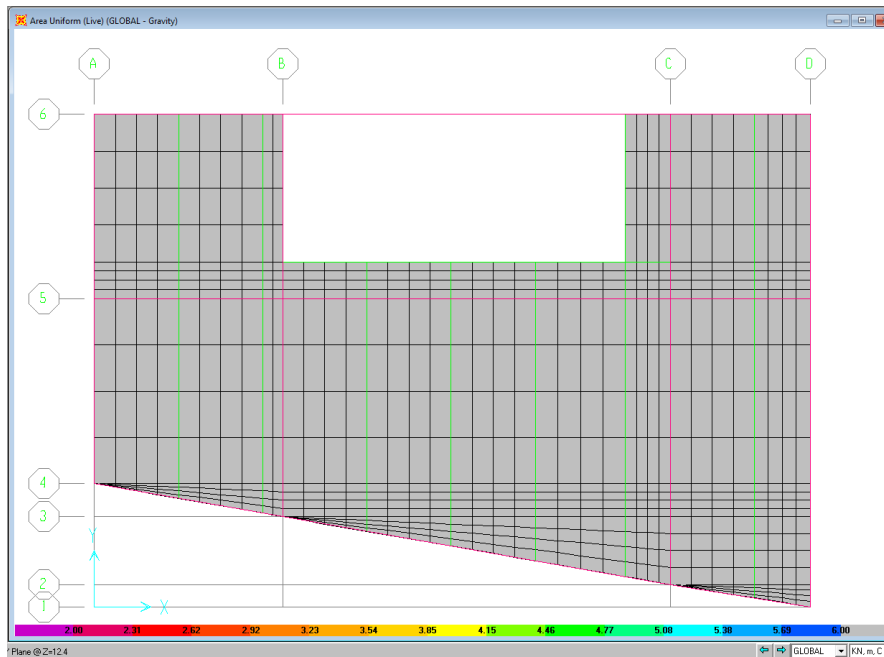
Planta nivel mezzanine módulo de acceso estación 17 costado oriental aplicación de la carga viva (6,0 kN/m<sup>2</sup>)
